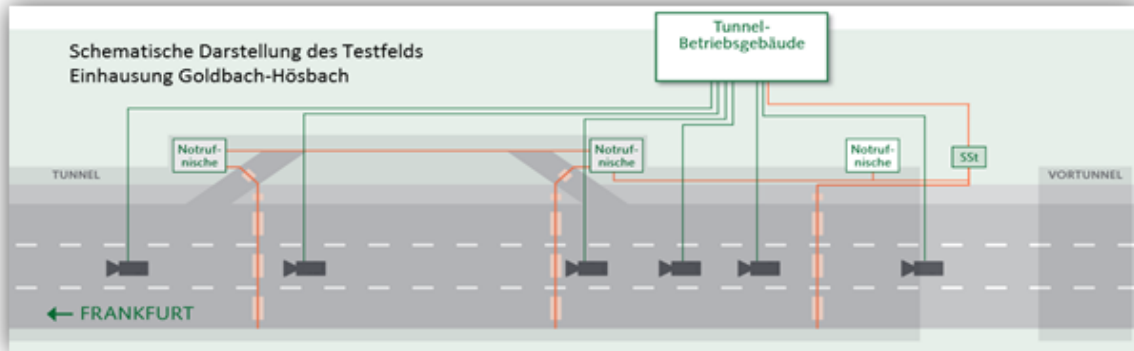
Schematisches Layout des Testfeldes im Hösbachtunnel
